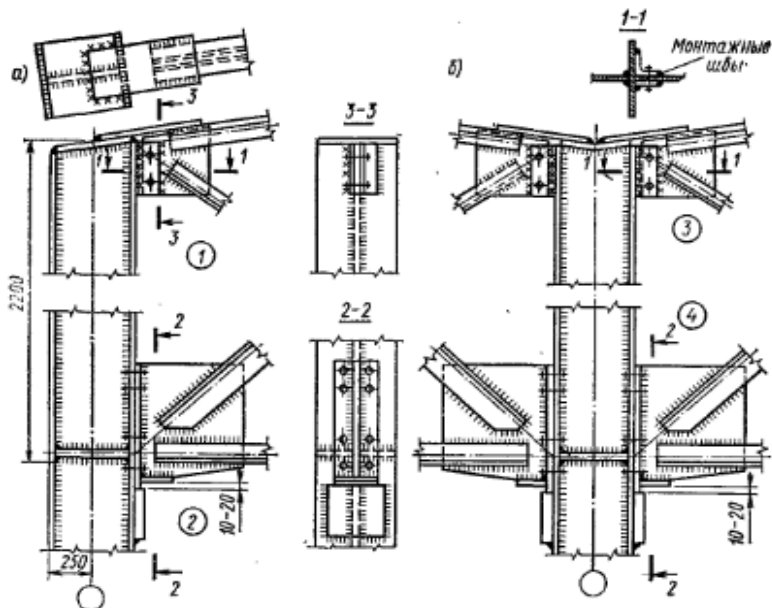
Вузли обпирання типової сталевій ферми на колони: а – на колону крайнього ряду; б – на колону середнього ряду
